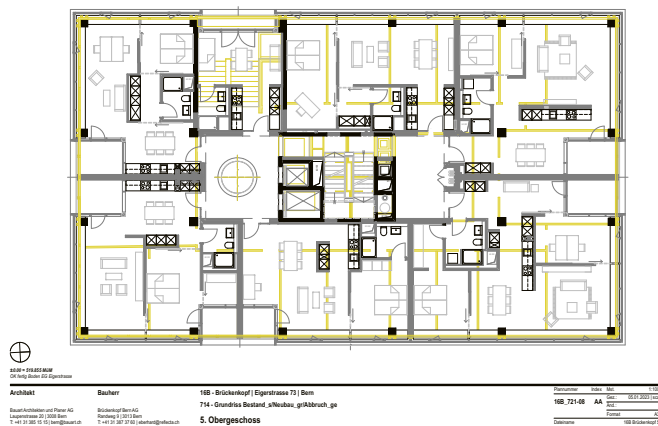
Grundriss 5. Obergeschoss neu
